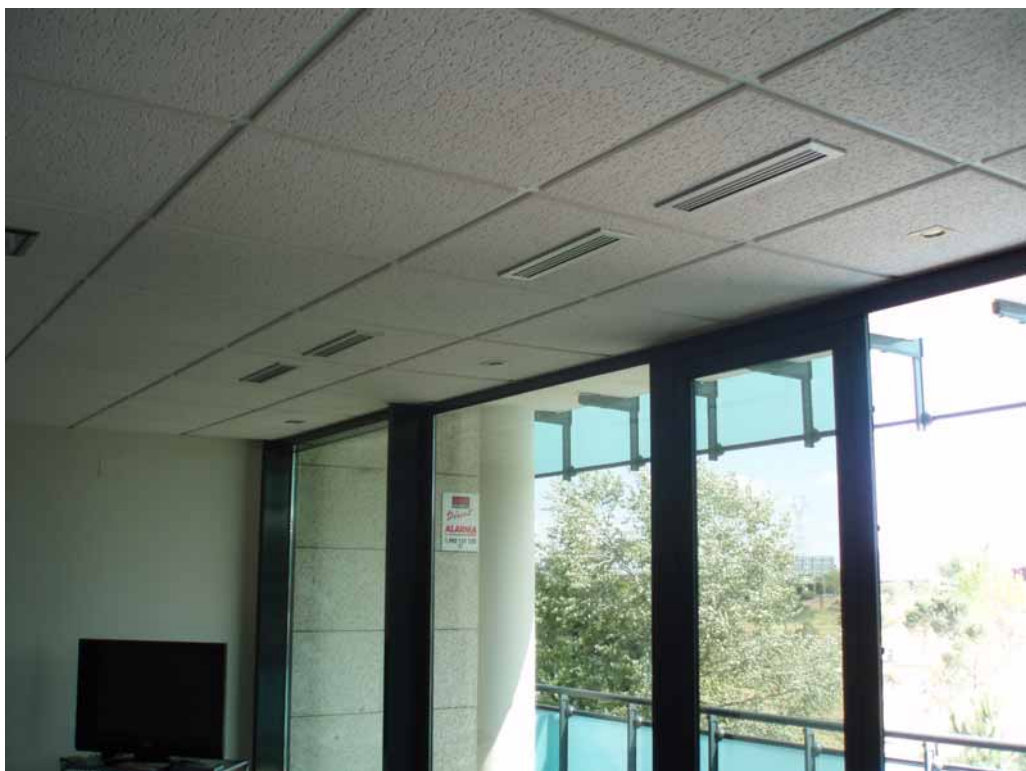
Rejillas para climatización y aporte de aire exterior en las instalaciones de Geoter.
